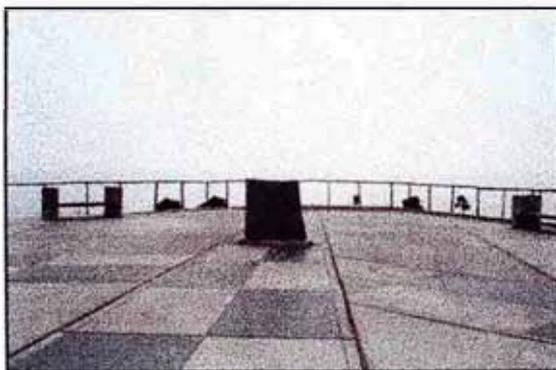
Estado del pavimento, en mal estado en algunas partes.
